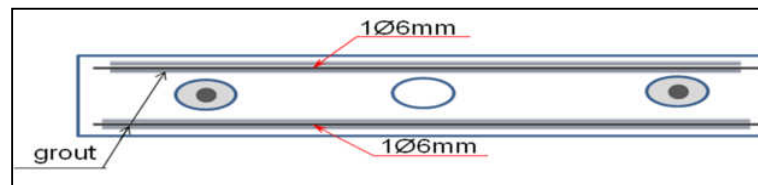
Sección transversal del murete M2 en zona del refuerzo horizontal.
